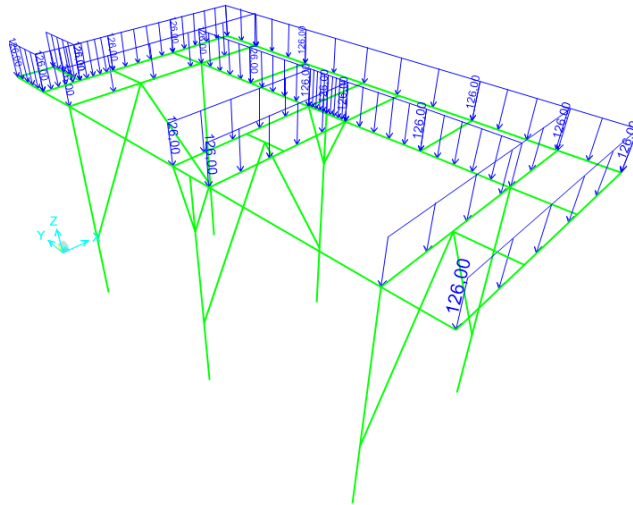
Aplicación de cargas por peso de plancha zona 4
